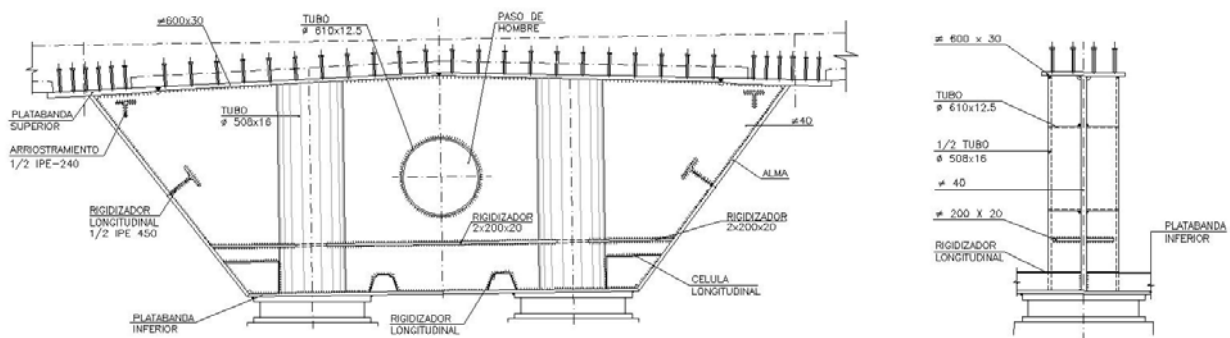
Diafragma sobre pilas; a) Alzado; b) Sección
